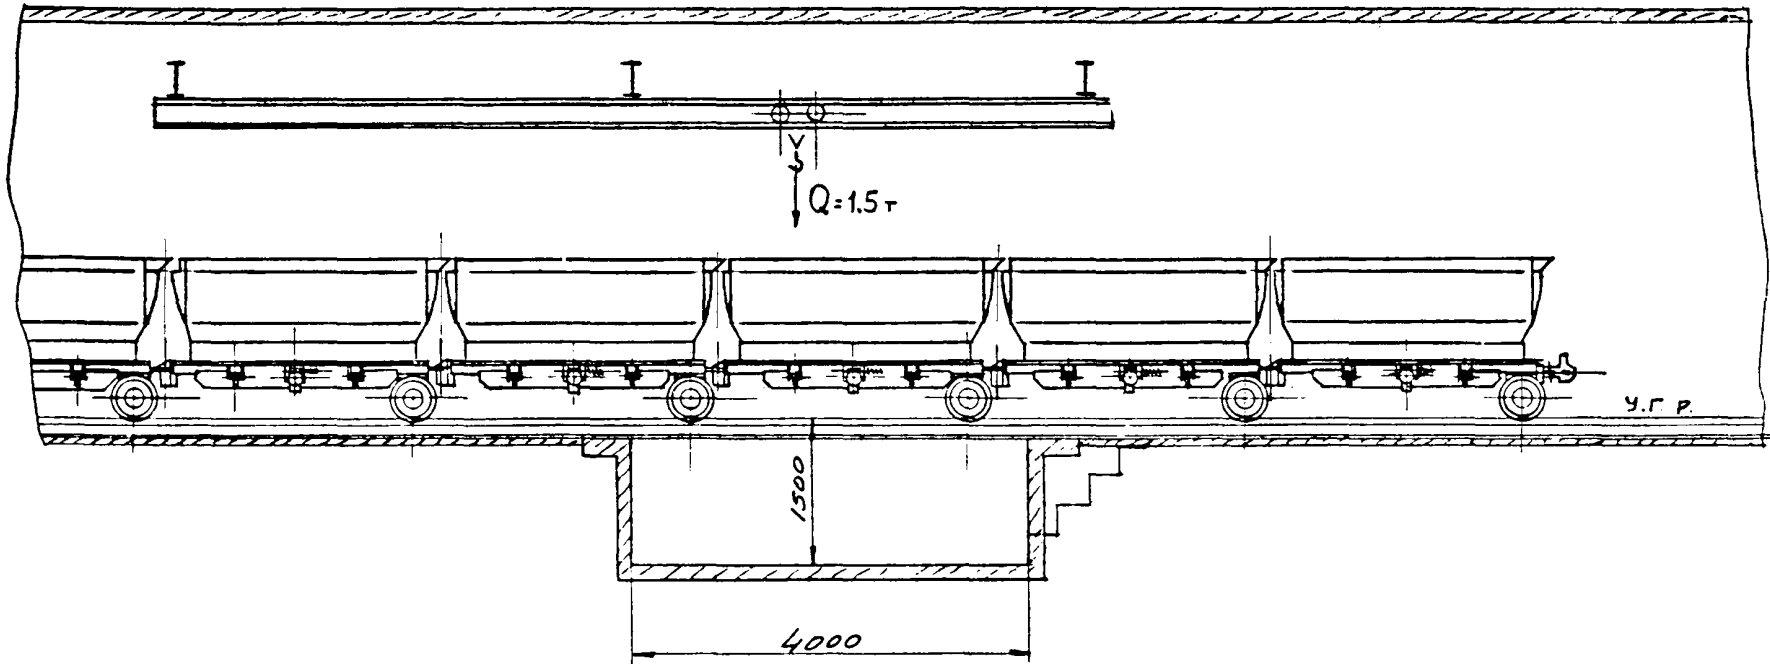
ВЫРАБОТКА ДЛЯ МОНТАЖА СЕКЦИОННОГО ПОЕЗДА
